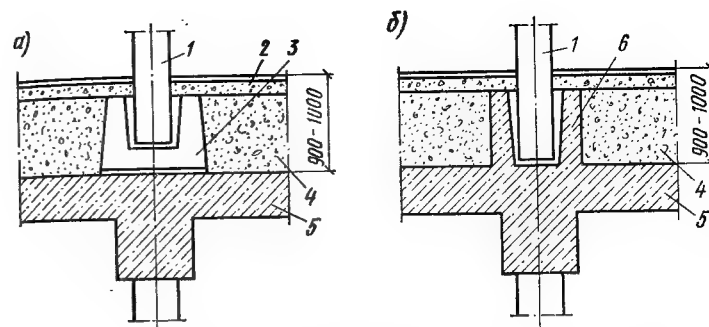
Схемы опирания каркаса здания на покрытие убежища
